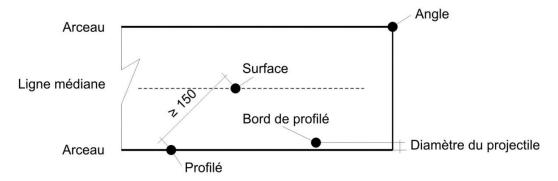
Points d'impact sur un store corbeille, vus en plan (dimensions en millimètres).
